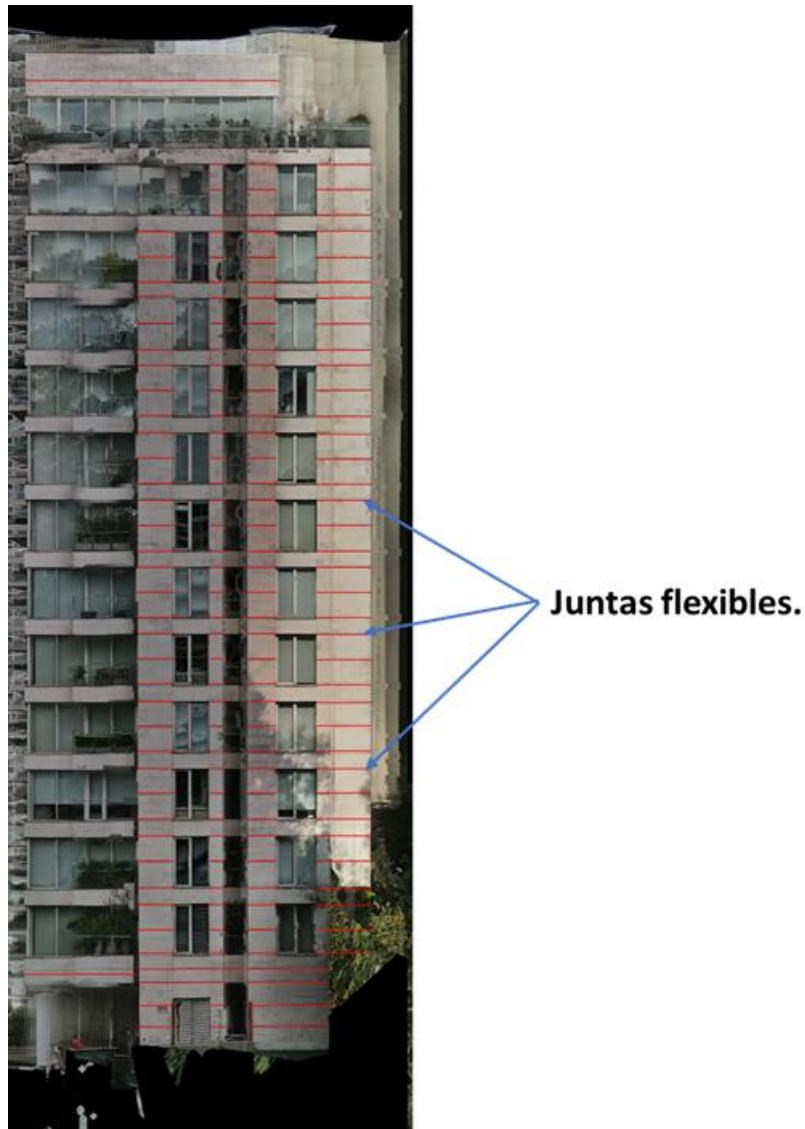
Fachada sur - ubicación de juntas flexibles.
